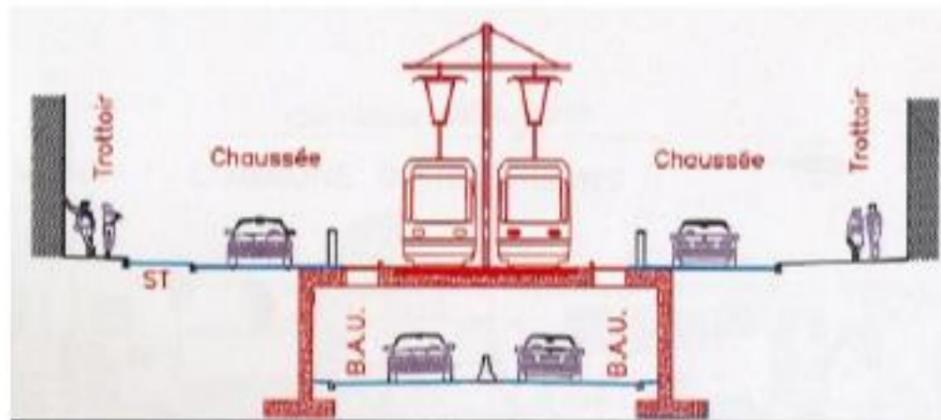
Extrait planches éclairage sur la 2<sup>ème</sup> phase joint au schéma de principe tramway Villejuif – Juvisy-sur-Orge, 1<sup>ère</sup> phase, RATP (mars 2002)
